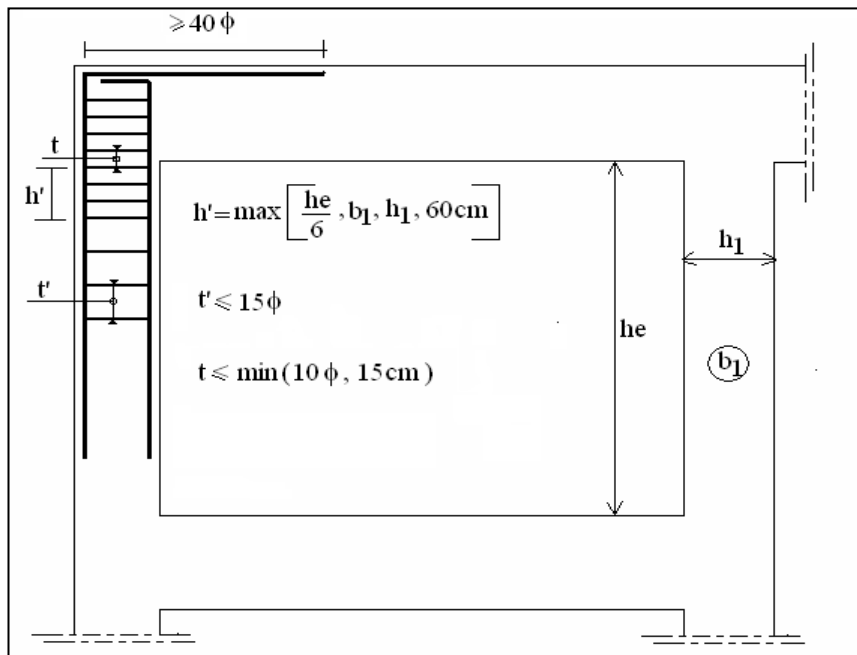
disposition constructives pour le ferrailage des poteaux (RPA99)
